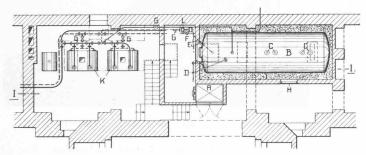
Grundriss und Schnitt der elektrischen Warmwasser-Heizanlage mit Wärmeakkumulierung im Schulhaus im Zelgli in Aarau. - 1:200.
